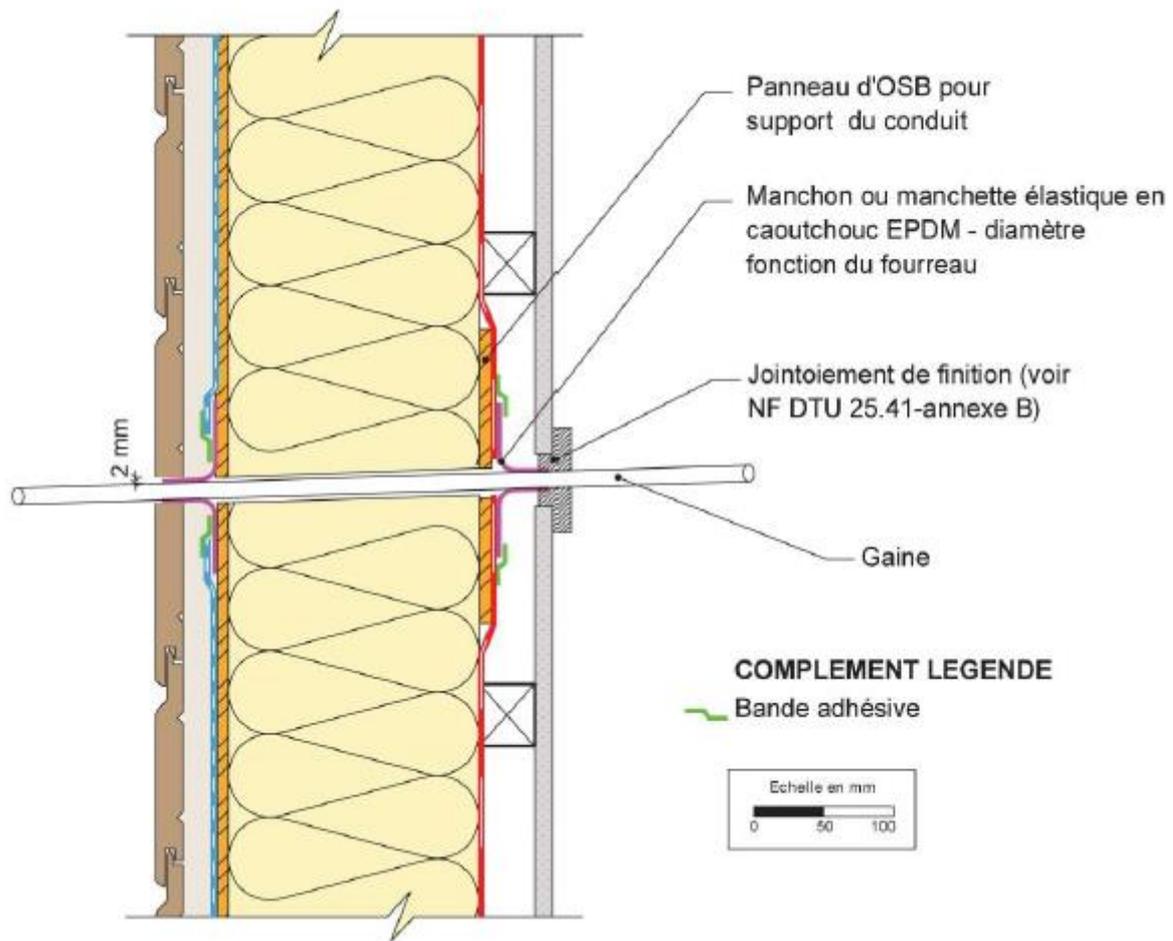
Raccordement de l'étanchéité à l'air et à l'eau en périphérie d'un élément traversant de diamètre inférieur à 16 mm par un manchon EPDM – niveau d'étanchéité Ee2 (coupe verticale)
